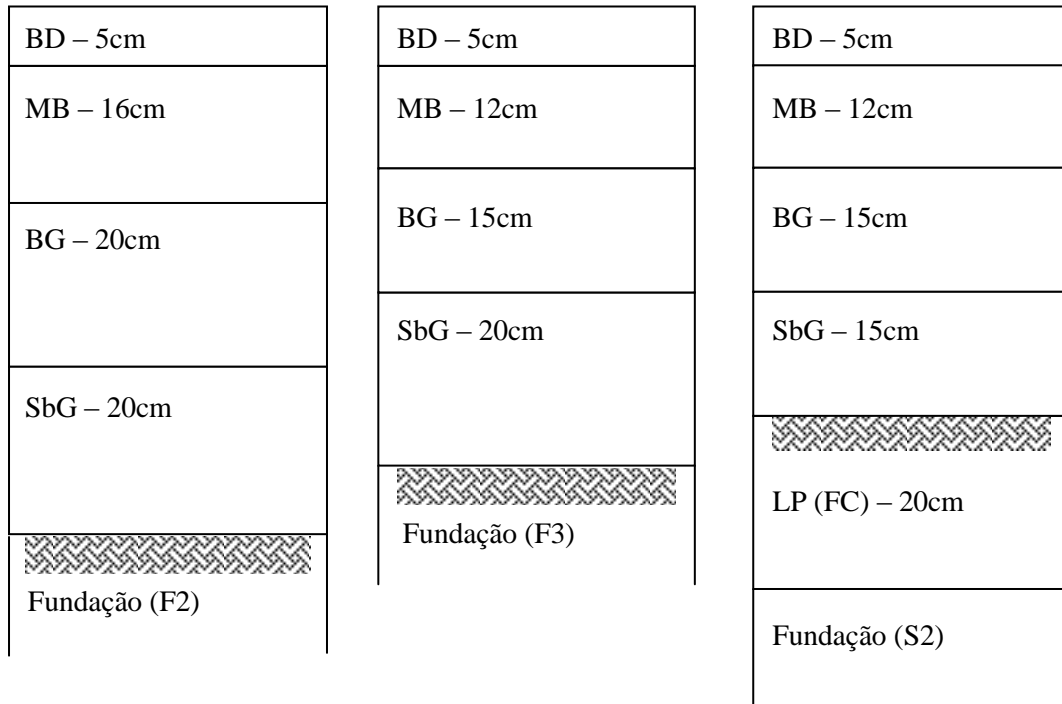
Comparação das estruturas de pavimentos obtidos
